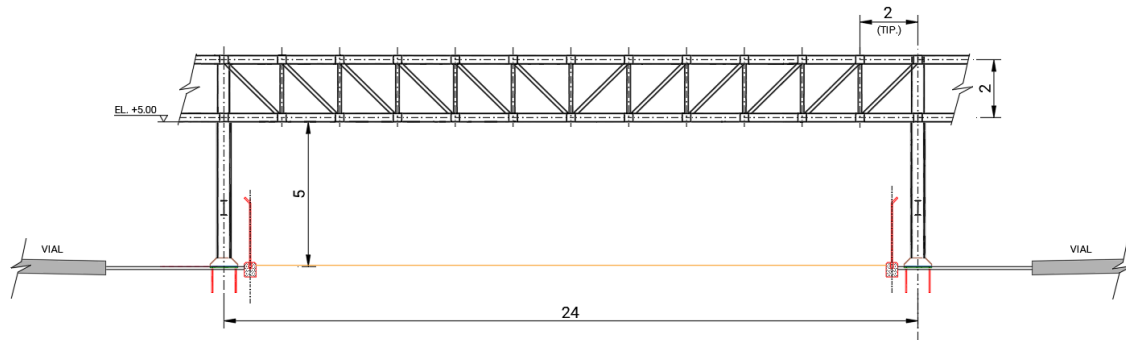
Viga cercha del puente de tuberías. Fuente: Proyecto Básico.
